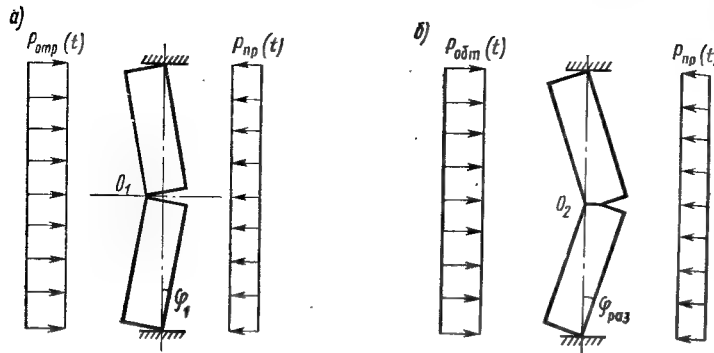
Расчетная схема разрушения кирпичных стен
